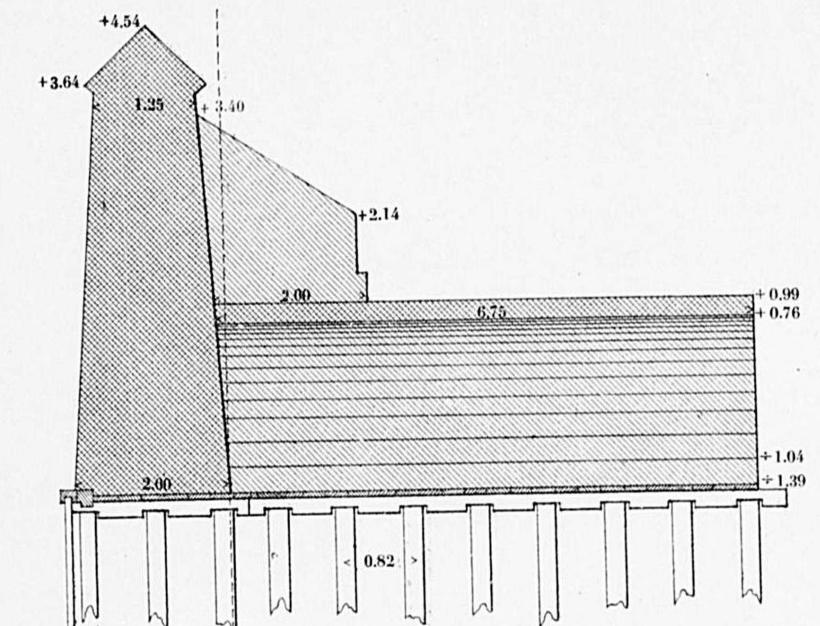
ZAMENSTELLING DER HOUTEN FONDERING. (1.20.)
